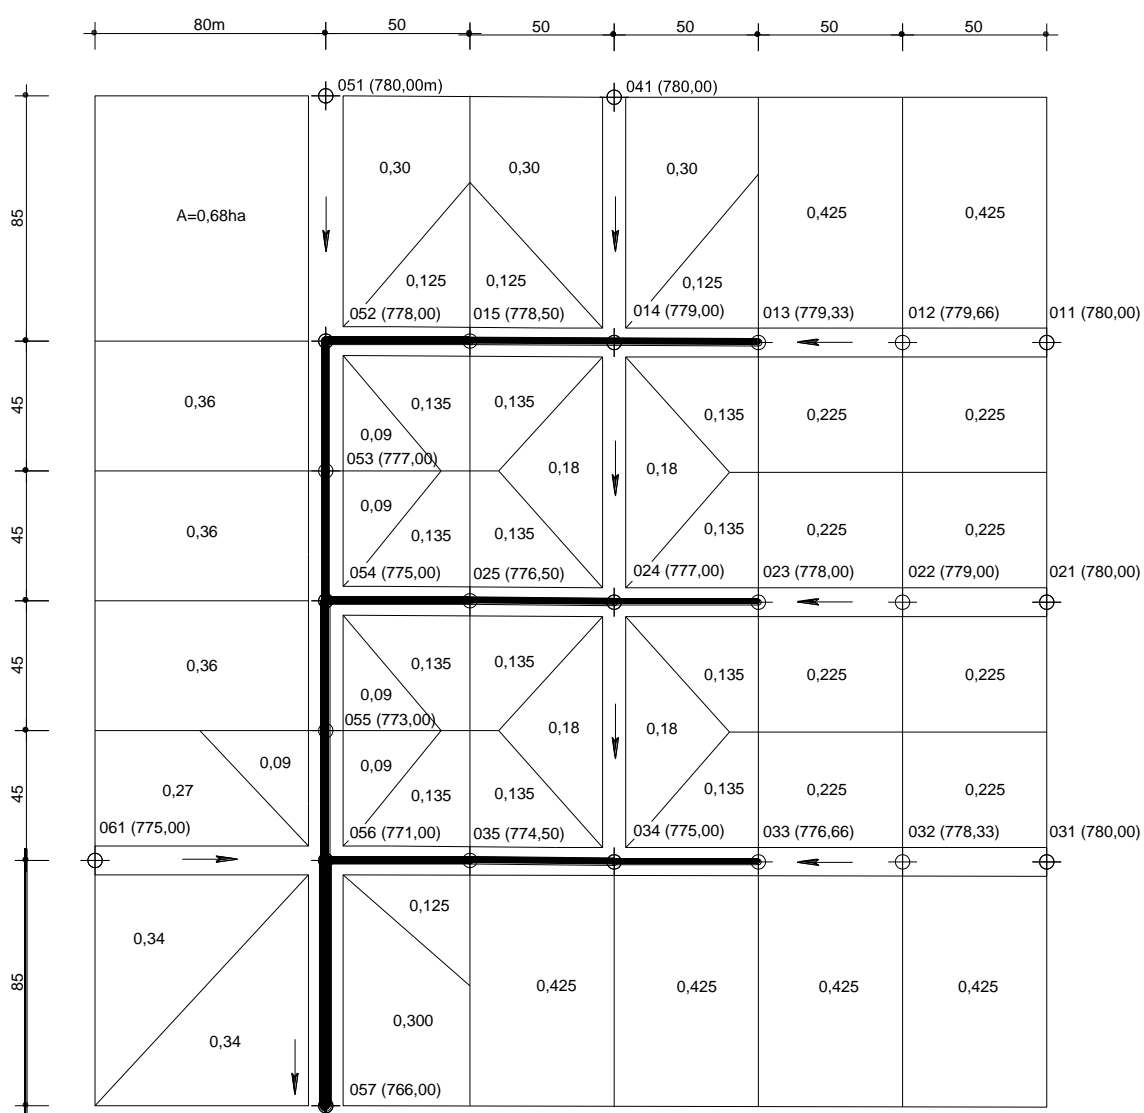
Planta baixa da área do projeto (loteamento residencial)
